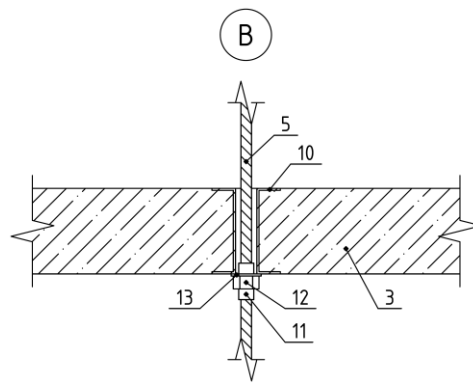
Узел крепления вантовых подвесов к плите перекрытия: 3 – перекрытие; 5 – подвеска; 10 – проходка; 11 – хвостовик; 12 – гайка; 13 – шайба
